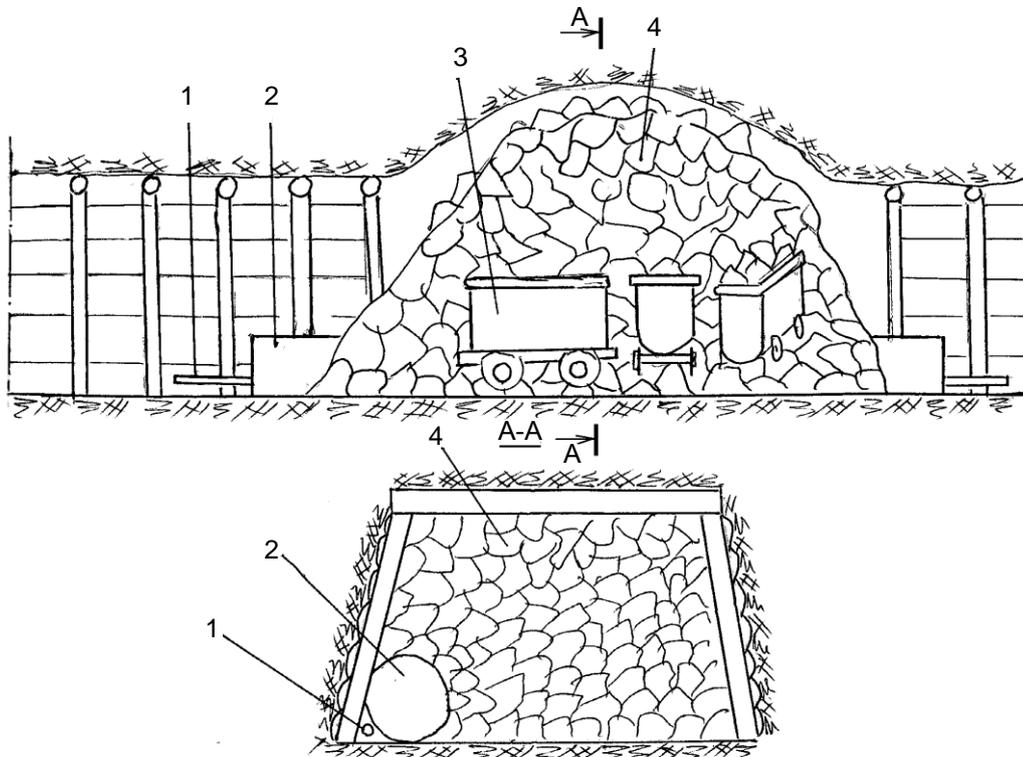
Барьерная перемычка из обрушенной породы (искусственный завал):
